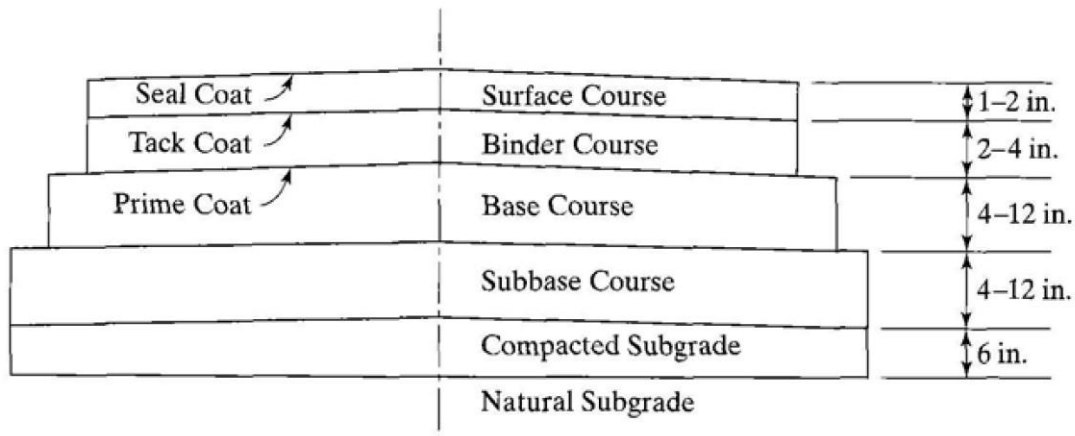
Sección típica de Pavimento Flexible. Fuente: Huang H. Yang (2018)
